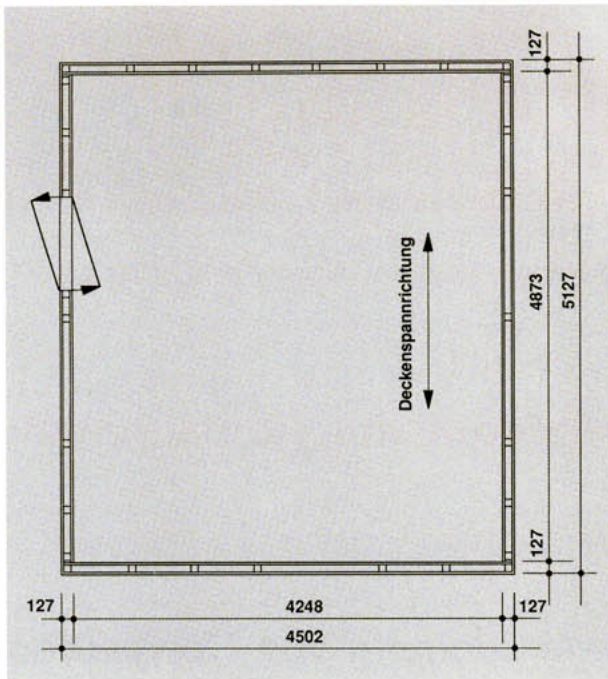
Grundriß des Prüfstandes (alle Maße in mm)
